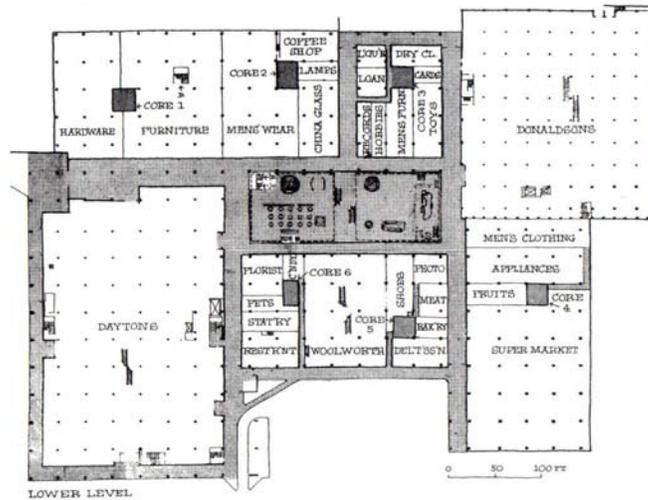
Minneapolis, Grundriss Erdgeschoss
